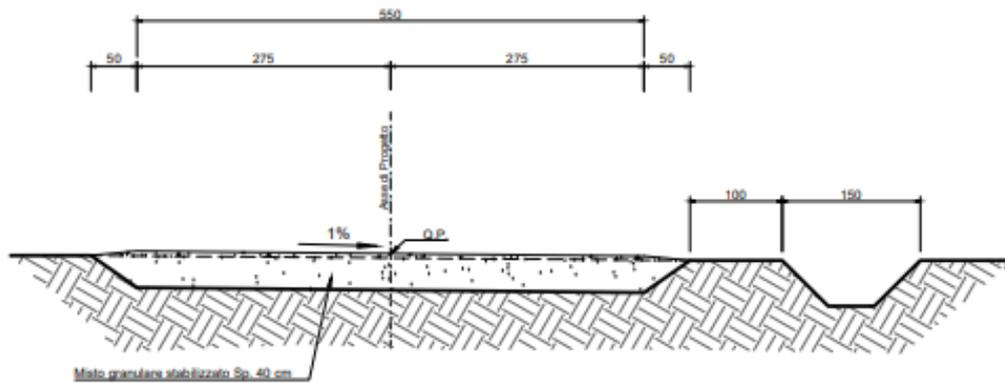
STRALCIO ELAB. 27_T00IA40AMBST04A - SEZIONE TIPOLOGICA VIABILITÀ DI SERVIZIO EST
